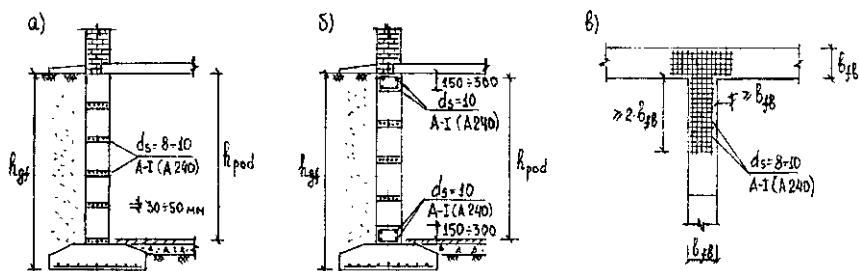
Конструктивные мероприятия по увеличению пространственной жёсткости стен ленточных фундаментов: а – армирование горизонтальных швов, б – армированные пояса из монолитного железобетона, в – армирование горизонтальных швов перевязки продольных и поперечных стен
